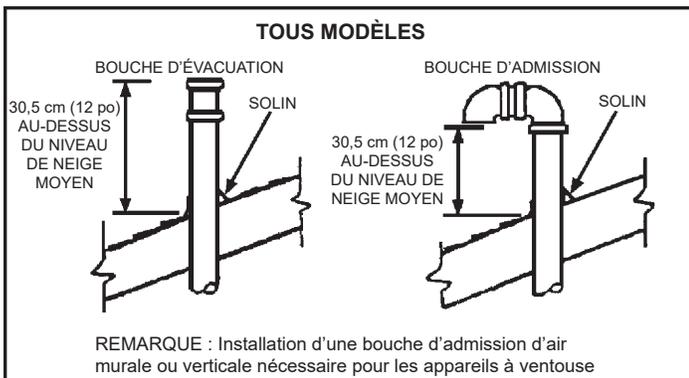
Dégagements pour la neige des bouches d'évacuation verticales sur toit en pente
